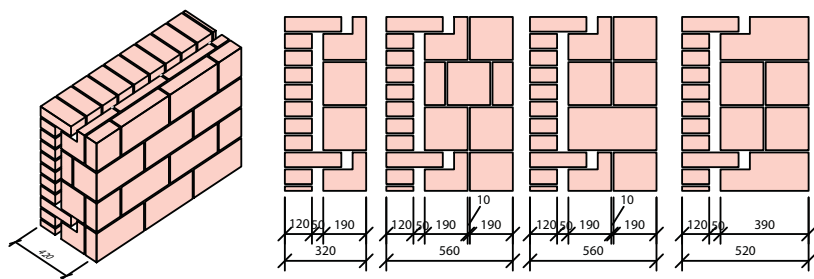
Кладка из бетонных камней (блоков) с облицовкой кирпичом с воздушной прослойкой [4], 1951 г.
